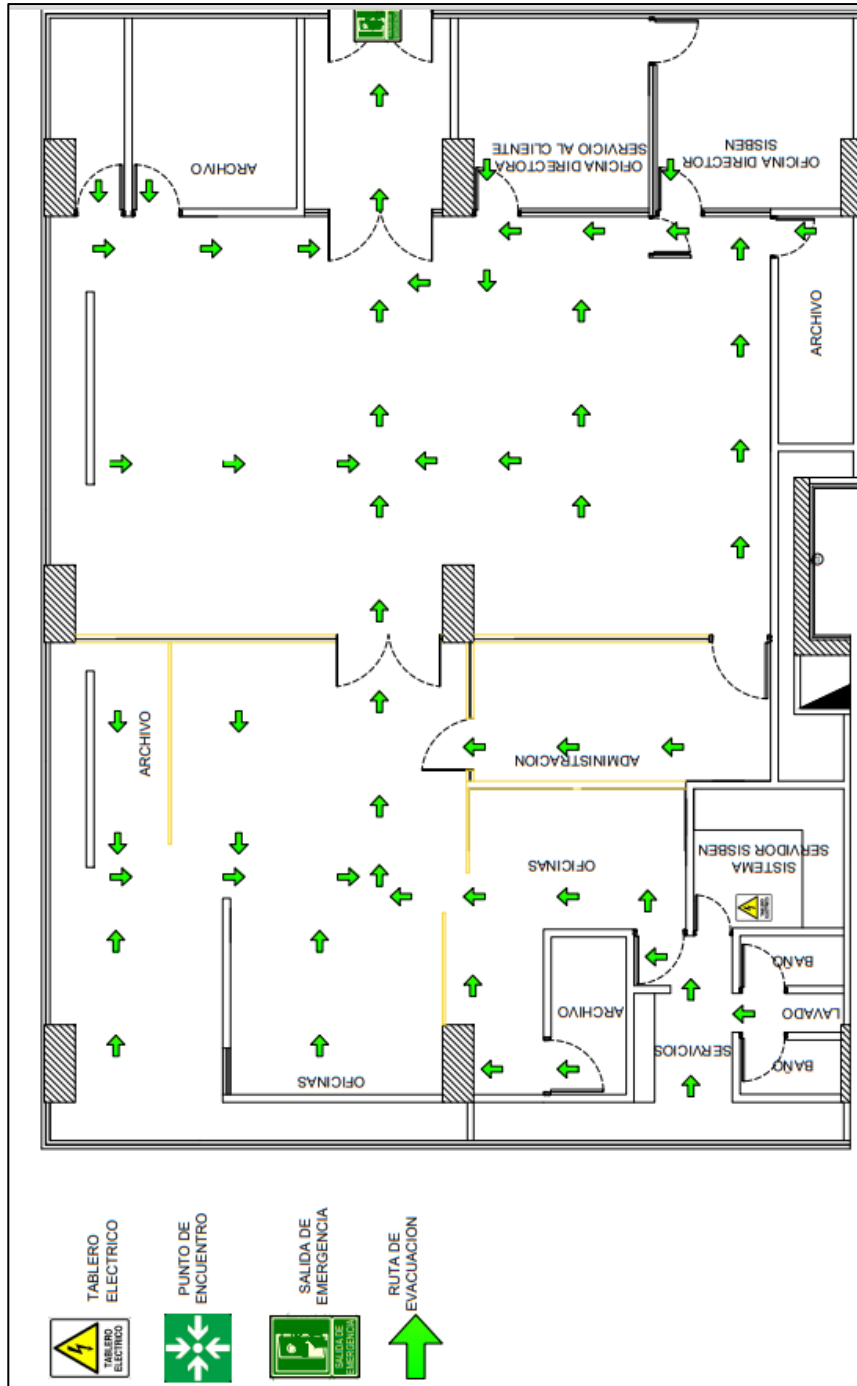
Planimetría propuesta para la nueva sede del Sisbén. Ruta de Evacuación.
